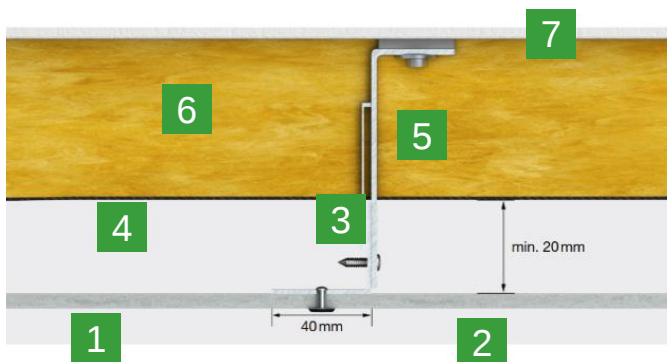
Sección horizontal. Apoyo intermedio.
